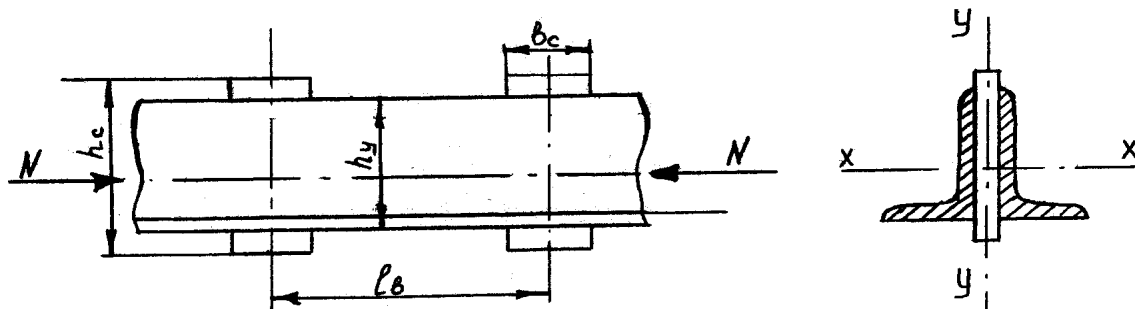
Установка соединительных планок (сухарей) в элементах фермы.
